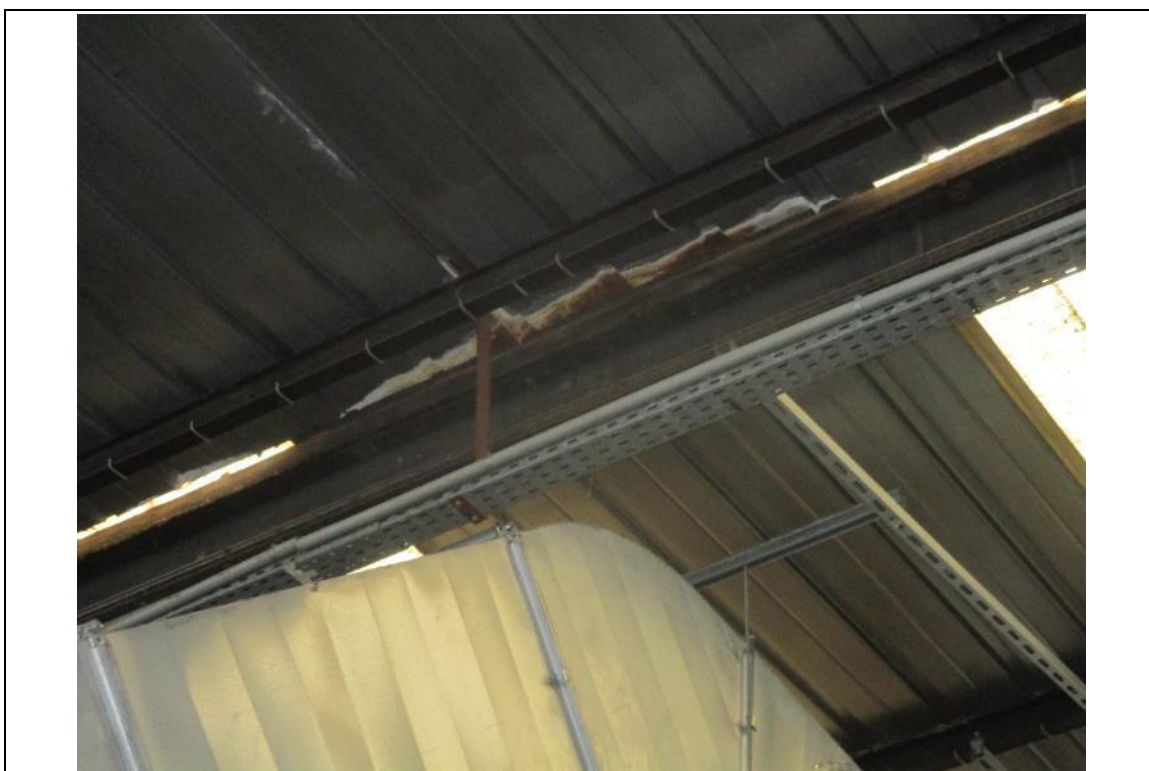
Corrosion feuilletante - Local 010, entre E6 et E7 au droit d'une gaine
